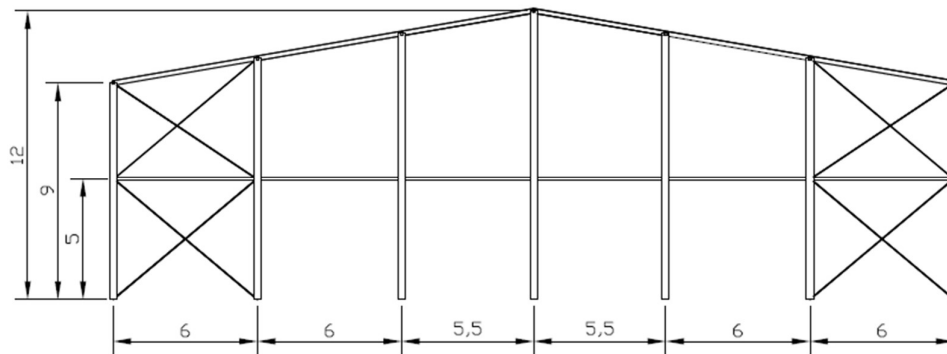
Alzado del pórtico de fachada (cotas en metros)
